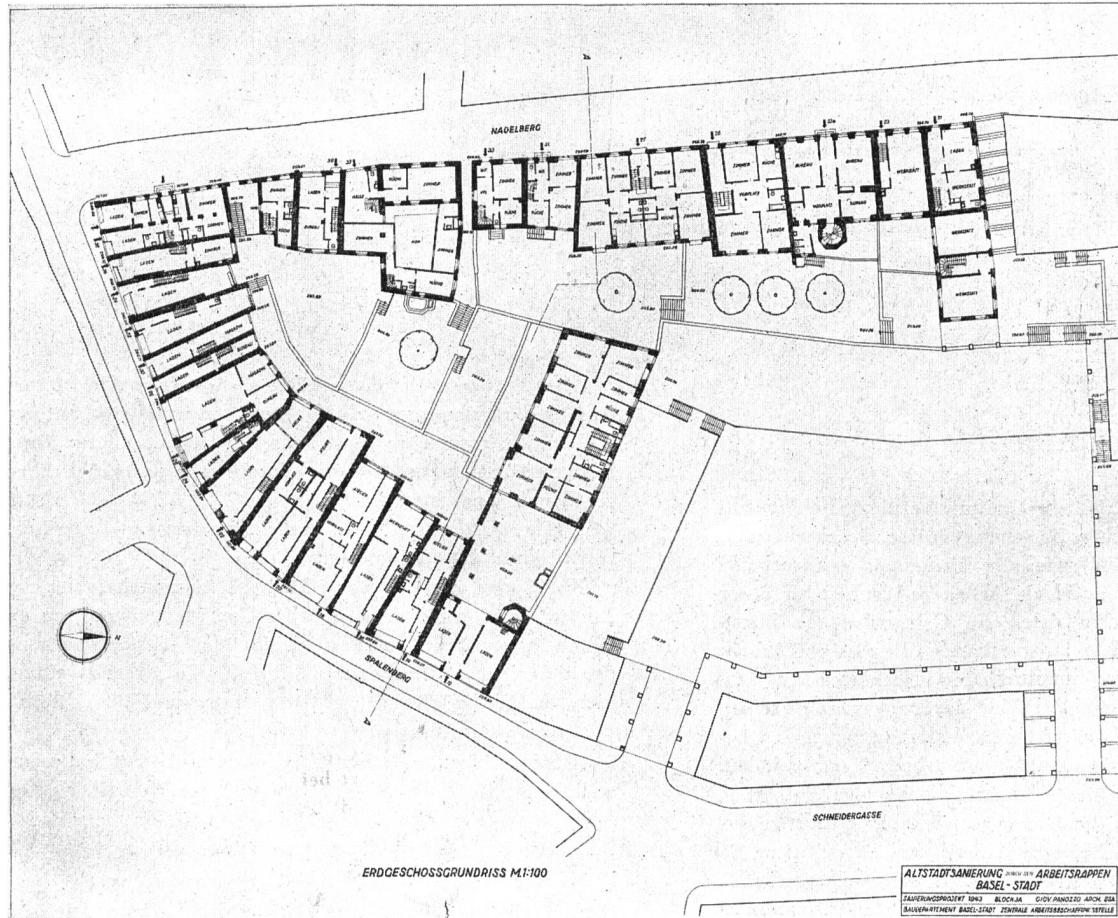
Erdgeschossgrundriss Block 3a, südlicher Teil, nach der Sanierung.
